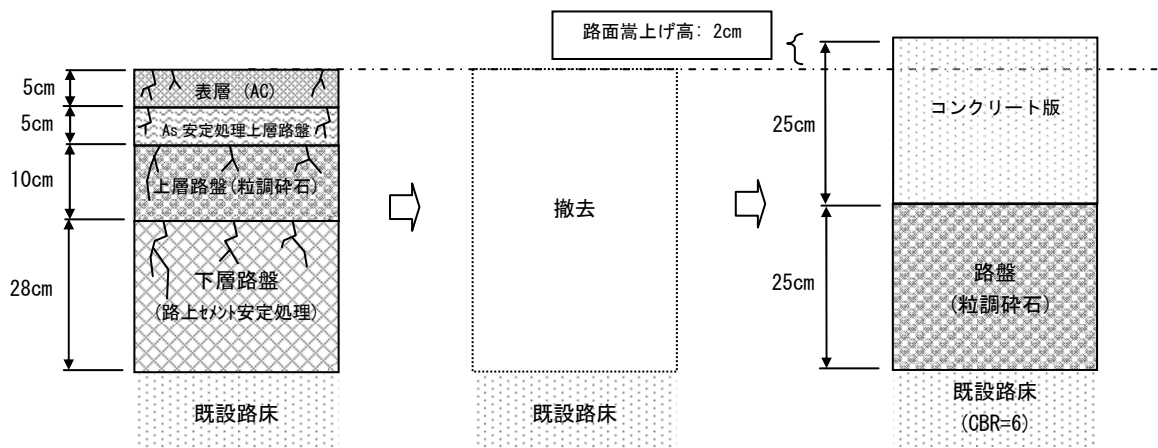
コンクリート舗装構造図（改修区間-1）
